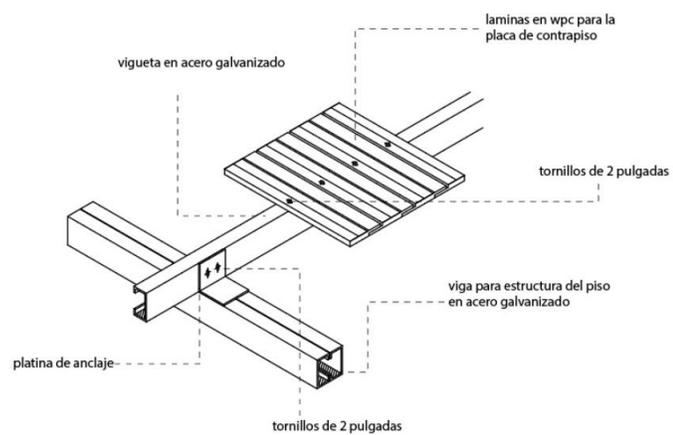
Detalle Constructivo Anclaje de tanques de flotación a plataformaNota. Elaboración propia*Figura 27*Detalle constructivo placa de contrapisoNota. Elaboración Propia
